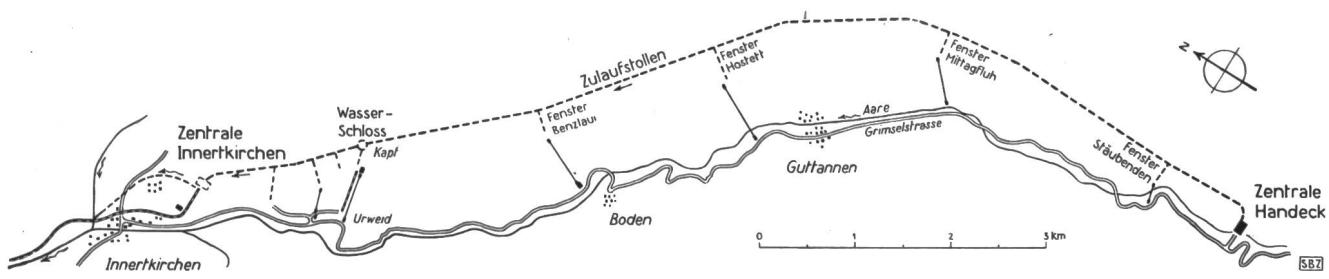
Lageplan 1:80 000 der Stufe Handeck-Innertkirchen. (Nr. 6057 BRB 3. 10. 39.)
